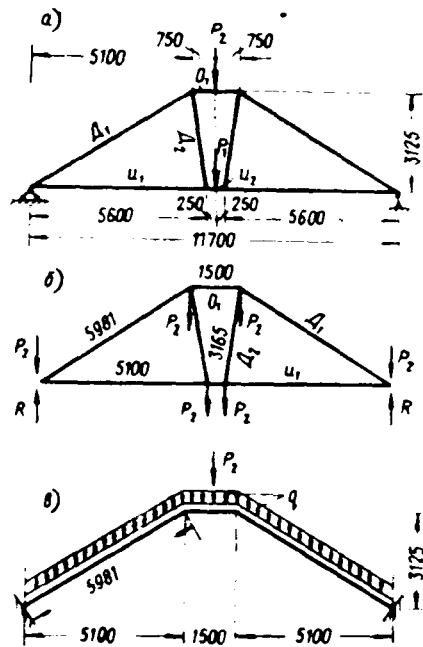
Пример сбора нагрузок и расчетной схемы для расчета подстропильной фермы
